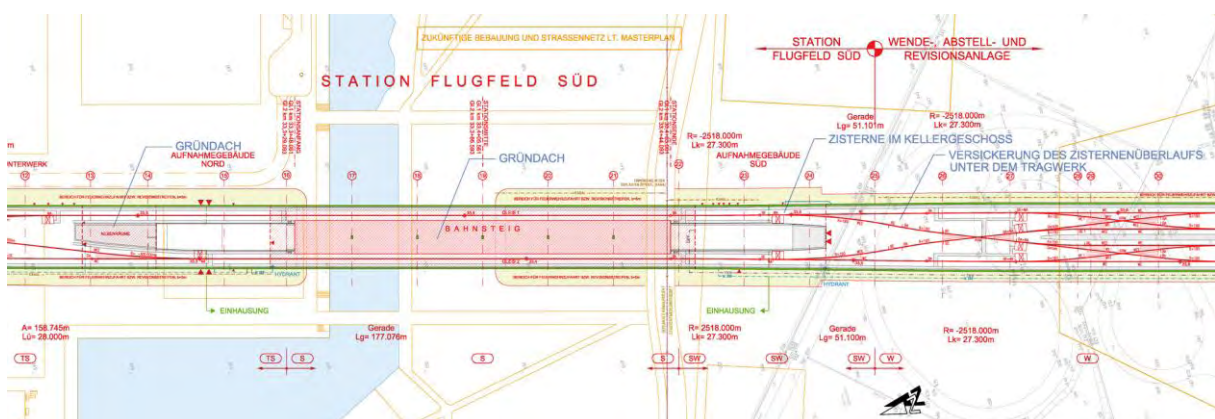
Ausschnitt Lageplan Station Seestadt mit Gründächern und Zisterne (Tecton Consult)
